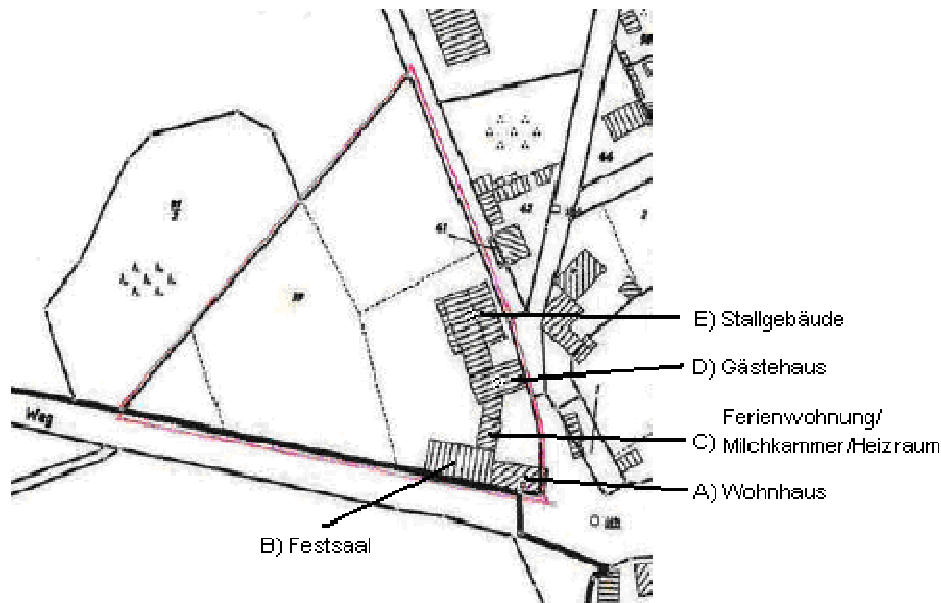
Flurplan mit Gebäudebezeichnungen
